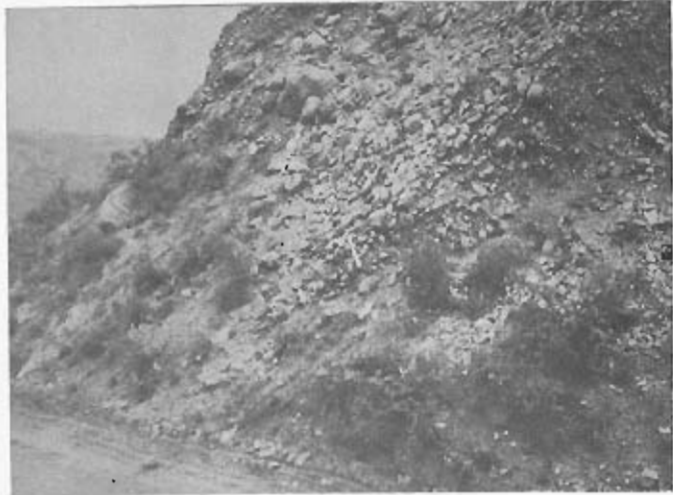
Degradación de un talud artificial excavado con inclinación excesiva en el grupo 321a (Cua. 167-3).
